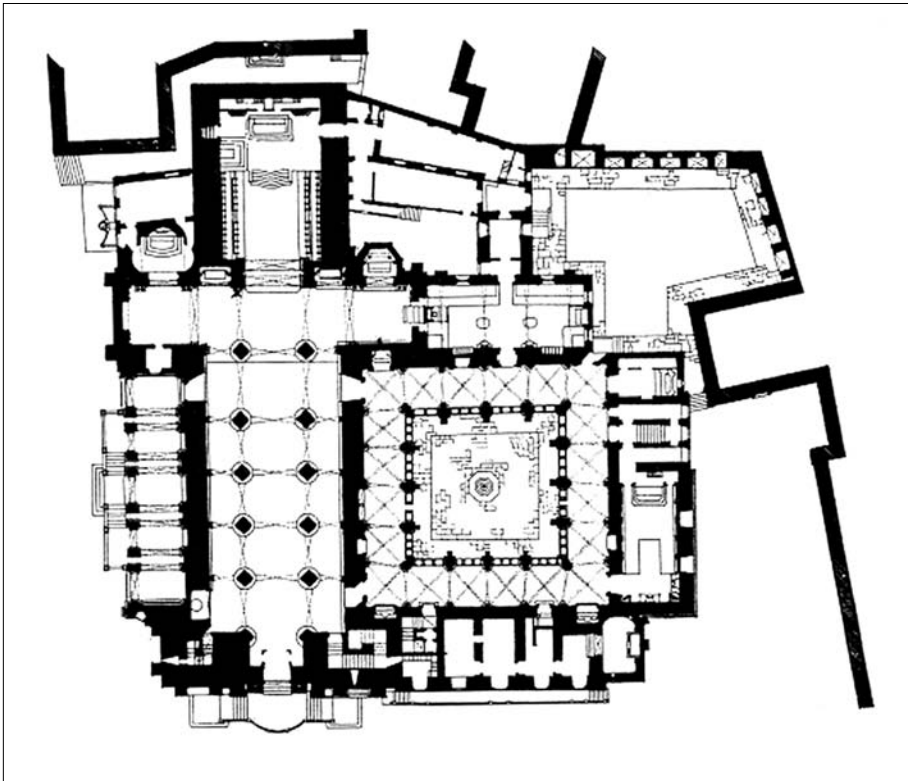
Catedral de Oporto. Planta general (D.G.E.M.N.).
